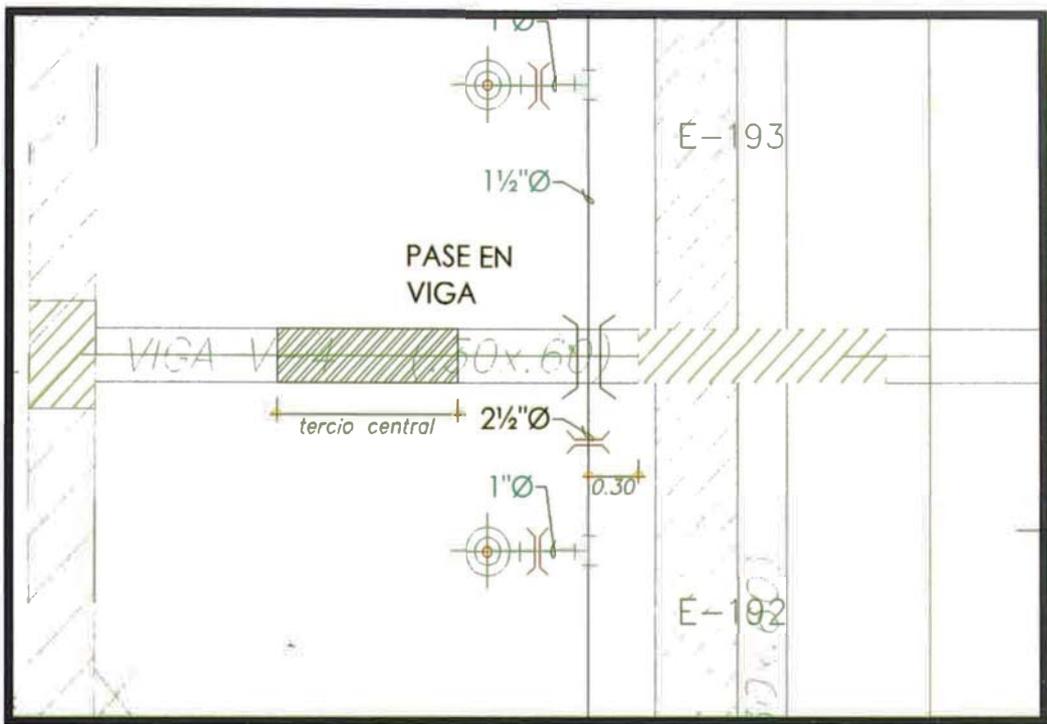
Acercamiento de intercepción de tubería de ACI con viga.
